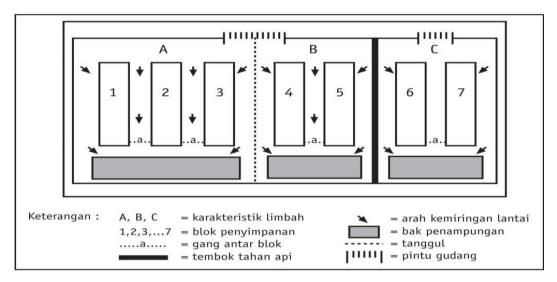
4 Contoh Rancang Bangun Fasilitas Penyimpanan LB3
